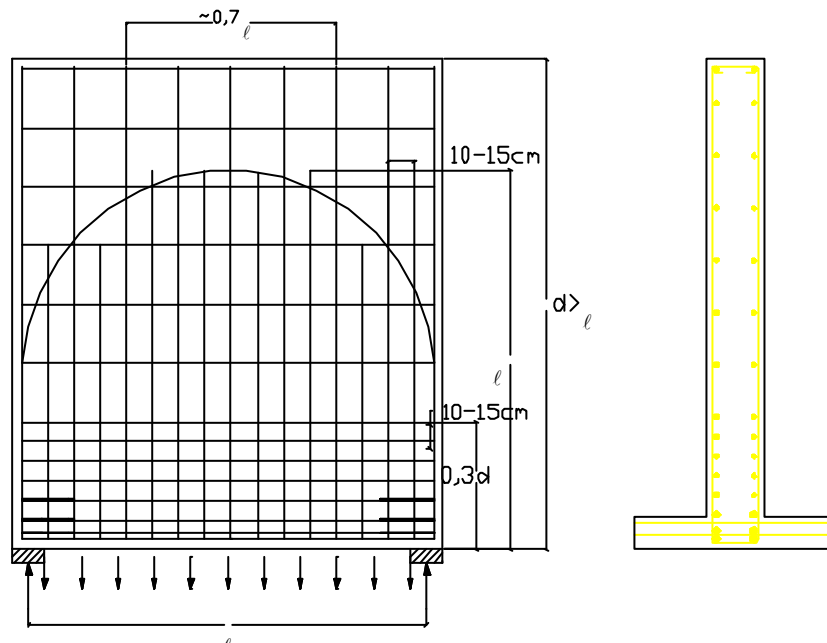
Armadura para uma viga-parede com apoio direto e carga pendurada (LEONHARDT,1979).
